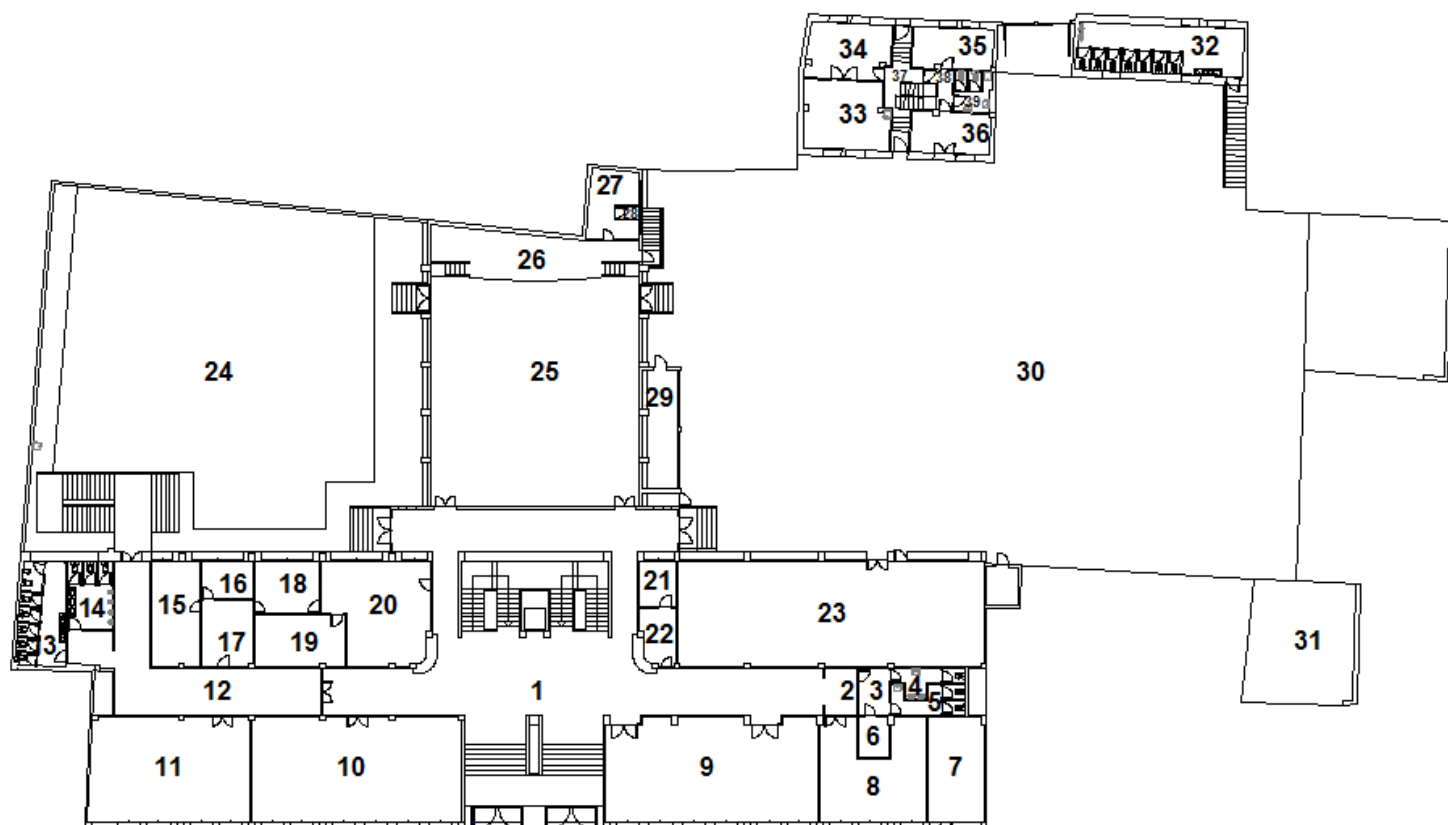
Distribución planta baja. Fuente: Elaboración propia.
